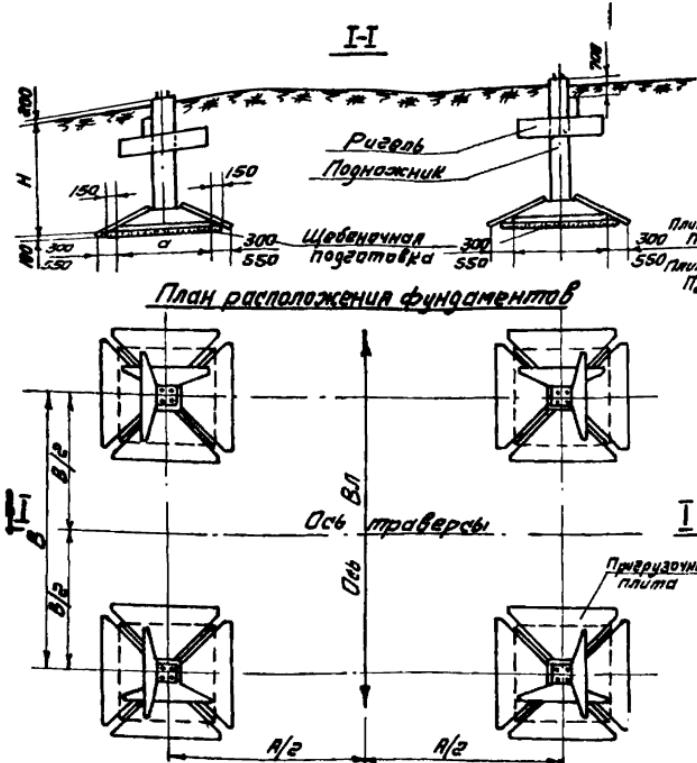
Схема расположения фундаментов под анкерно-чугловые опоры У1Ч2У1+5, У2+5, У1+12, У2+12
